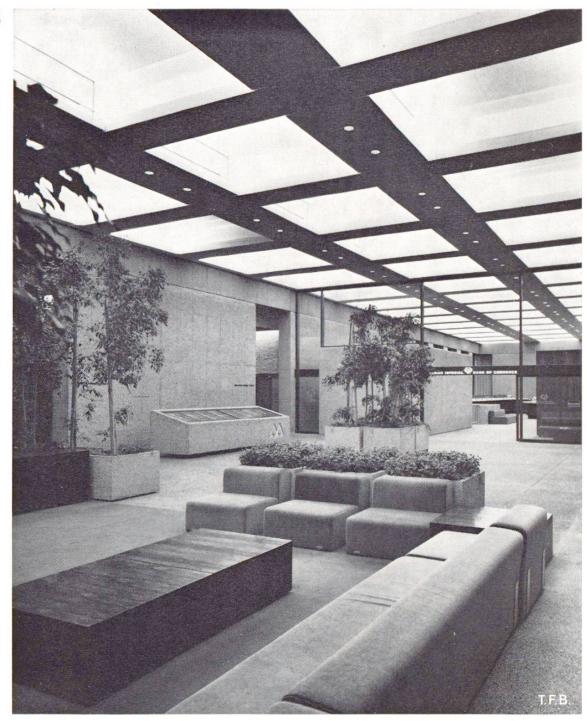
Vue du hall d'entrée de 6,5 m de hauteur. Là aussi, le béton est largement apparent.
